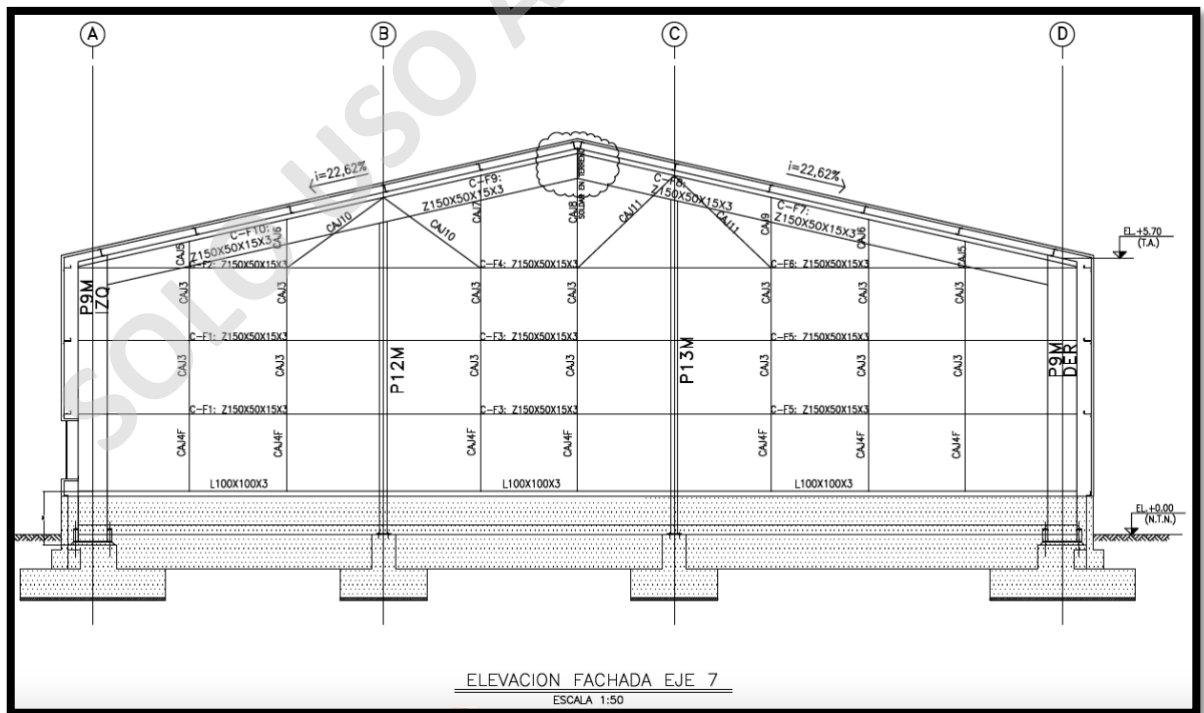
Elevación de Eje 7 Colgadores ODR Ingeniería y Montaje.
